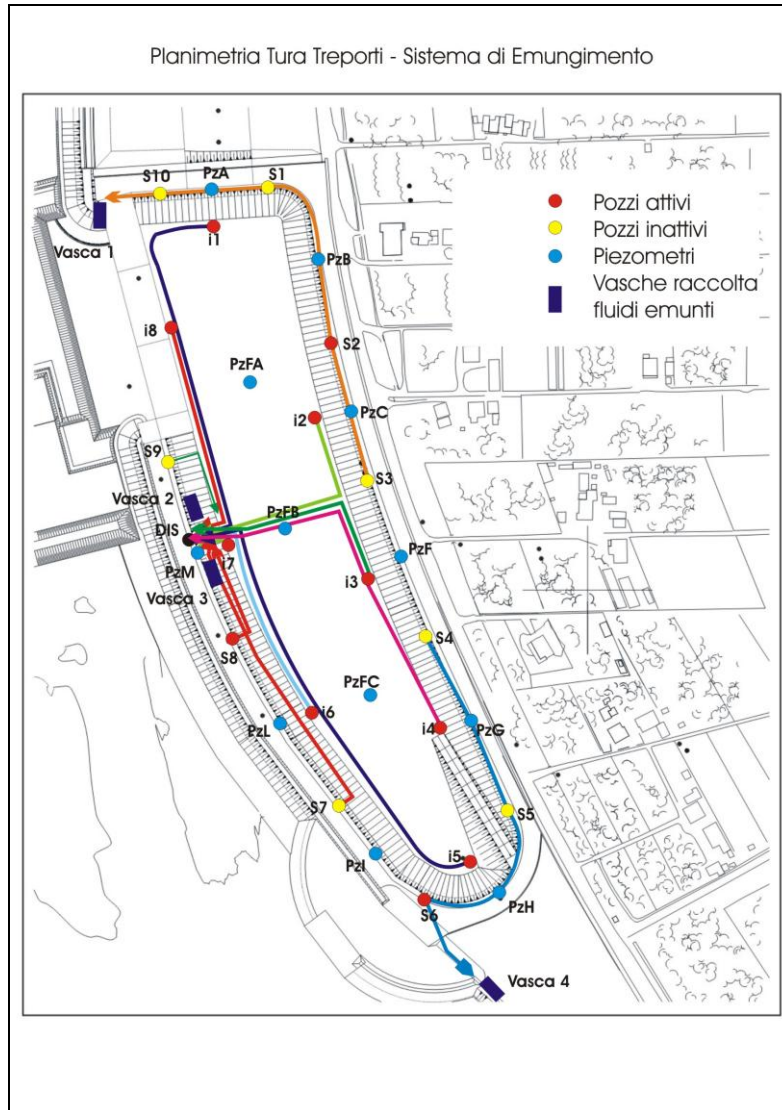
Planimetria del sistema di dewatering della tura (fonte: Consorzio Venezia Nuova).
